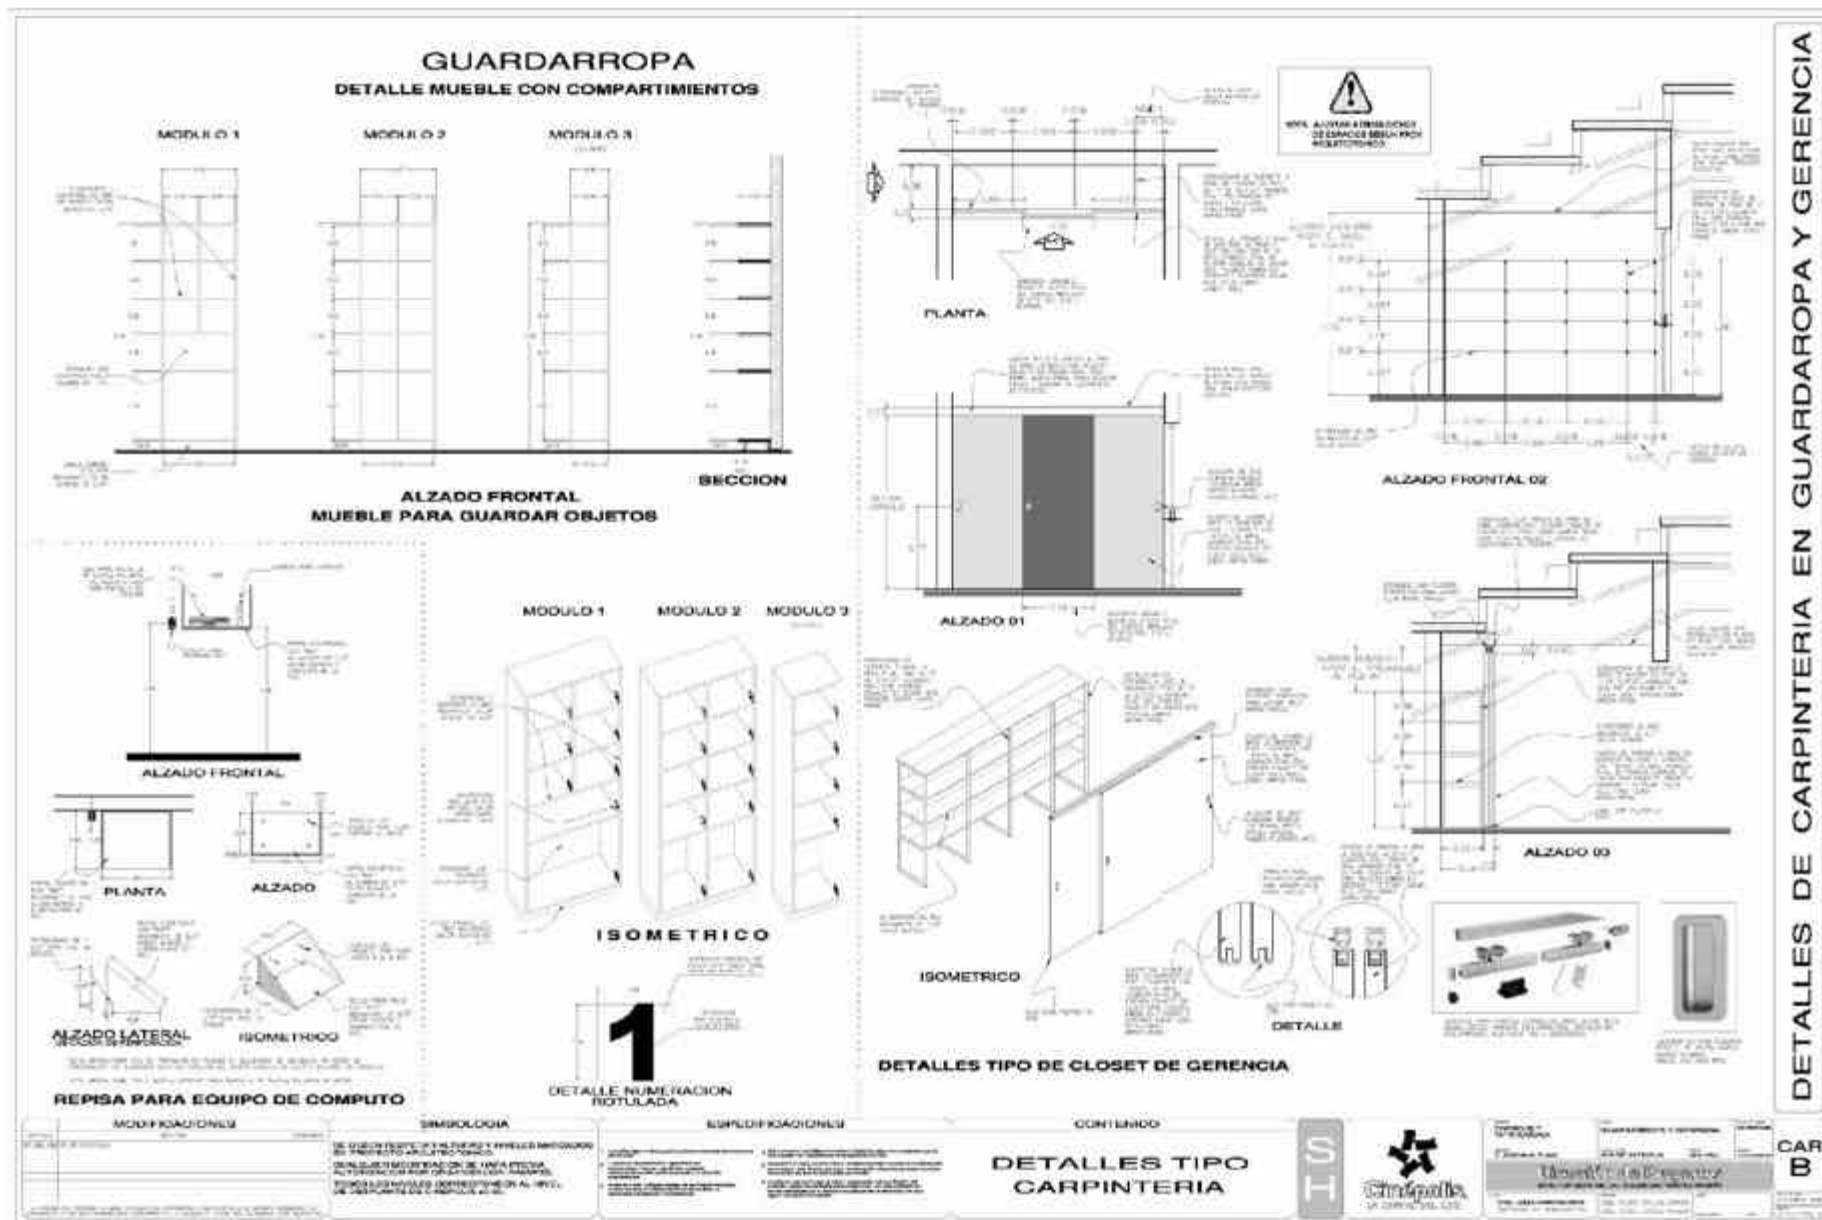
CAR-B Detalles de carpintería en guardarropa y gerencia
